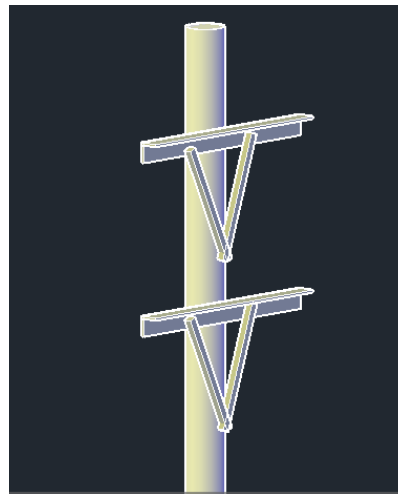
Diseño de cruzeta perfil L 2,4 m en AutoCAD 3D
